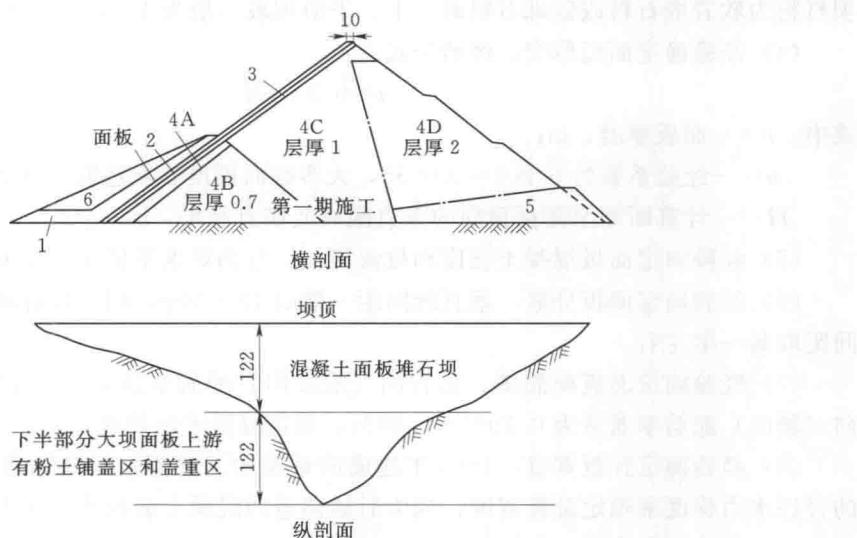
设想的高 244m 的混凝土面板堆石坝分区设计图（单位：m）
